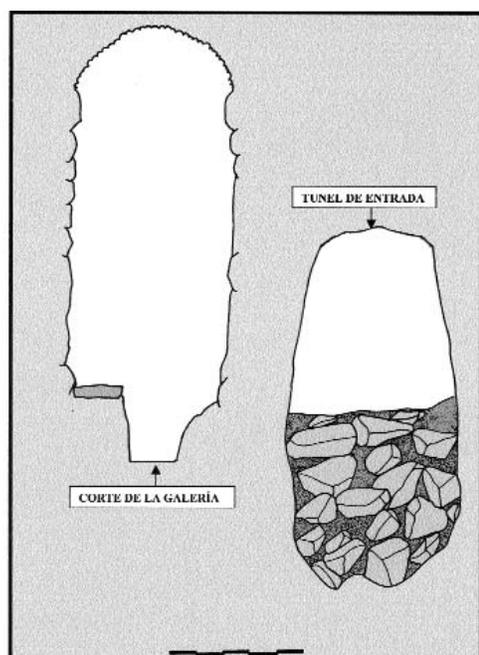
Corte transversal de la galería y del túnel de acceso.
